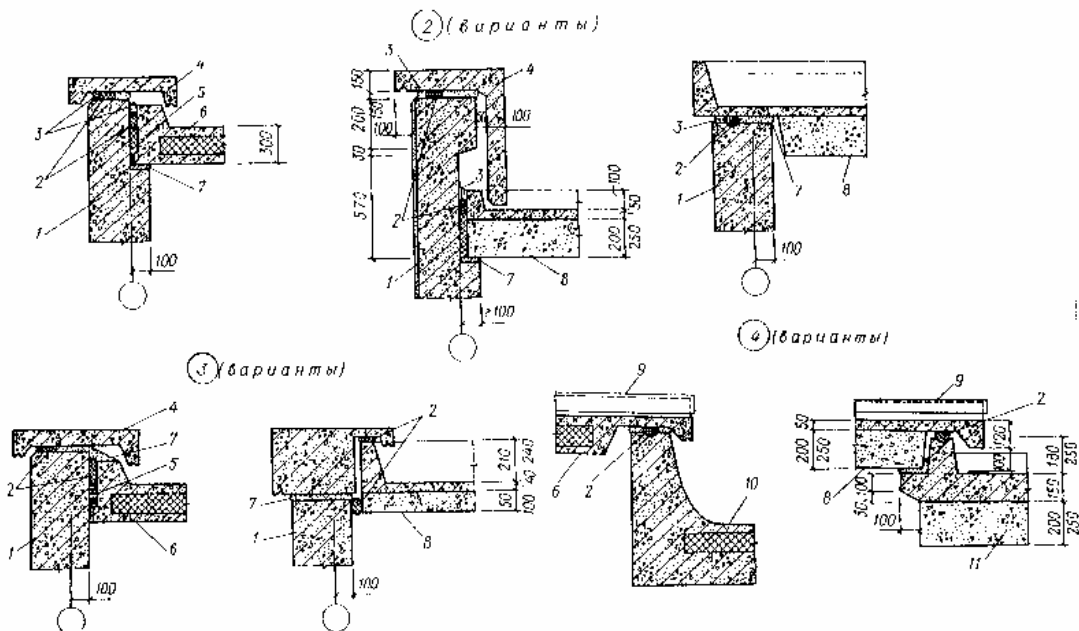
Узлы сопряжения конструкций безрулонной крыши с теплым чердаком (тип Г): 1 – фризровая панель; 2 – гернит; 3 – герметизирующая мастика; 4 – бетонный парапет; 5 – утеплитель; 6 – трехслойная кровельная панель; 7 – цементно-песчаный раствор; 8 – двухслойная кровельная панель; 9 – П-образный бетонный нагельник; 10 – лотковая трехслойная панель; 11 – двухслойная лотковая панель
